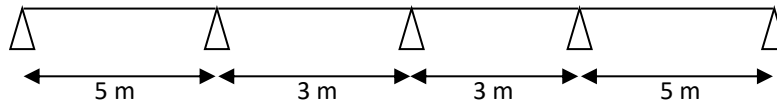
Schéma du 1^{er} type de poutrelle
